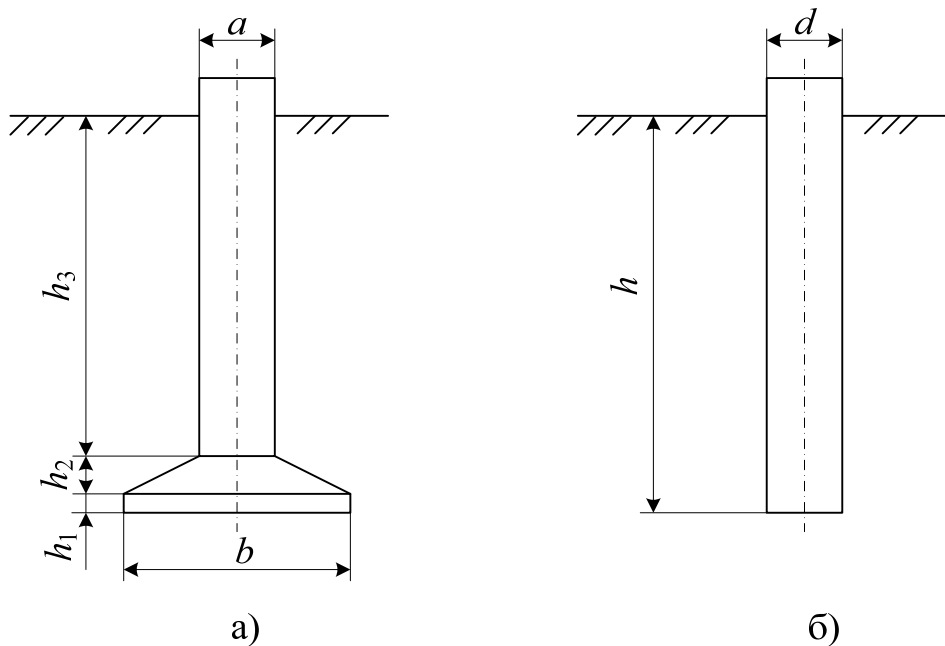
Природні зосереджені заземлювачі: а – залізобетонний підножник; б – залізобетонна стійка
